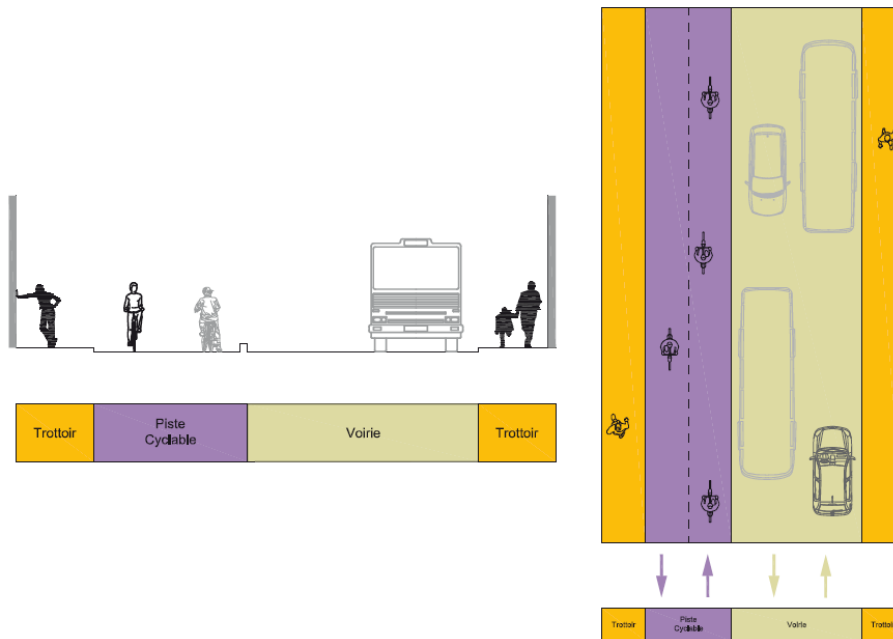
Profil en travers schématique, issu du document « Réflexions usages secteur pont de Tasdon »
